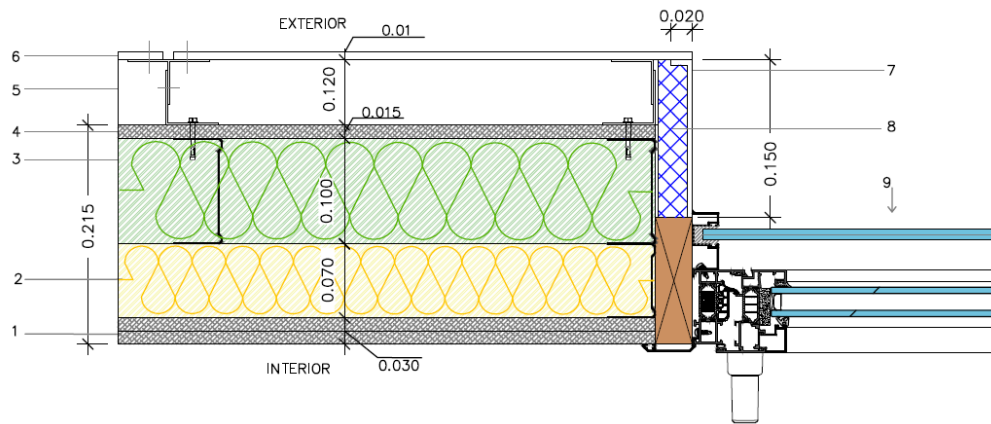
Sección constructiva, corte horizontal, de la propuesta de fachada ligera, tabiquería seca, a estudio.
